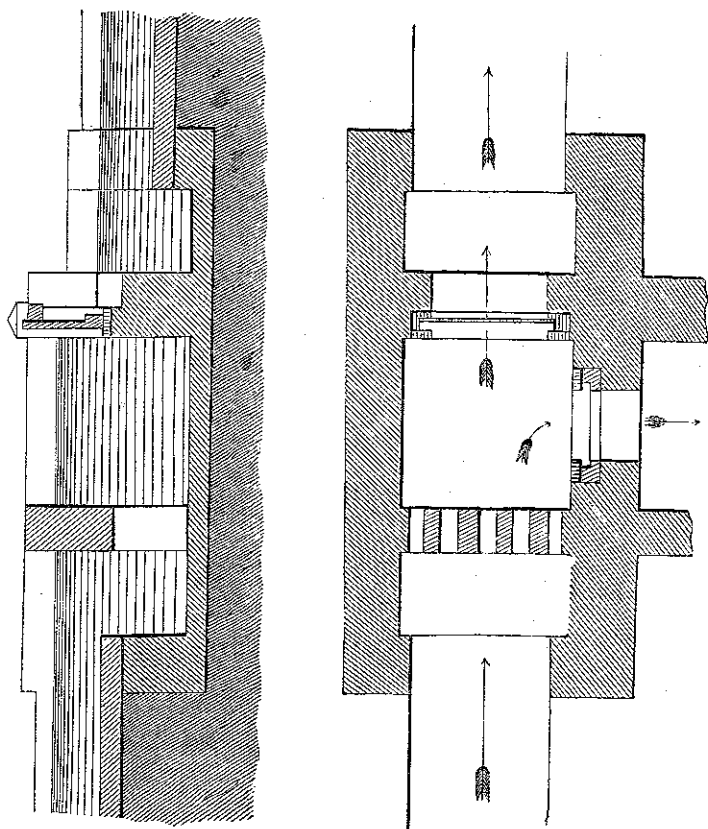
, 13 y 14.—Corte longitudinal. Planta Sección *nn* del modulo usado en el canal del Henares.
